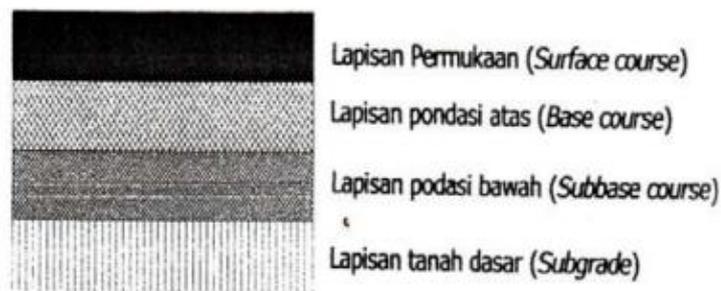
Lapisan Konstruksi Pekerjaan Jalan
